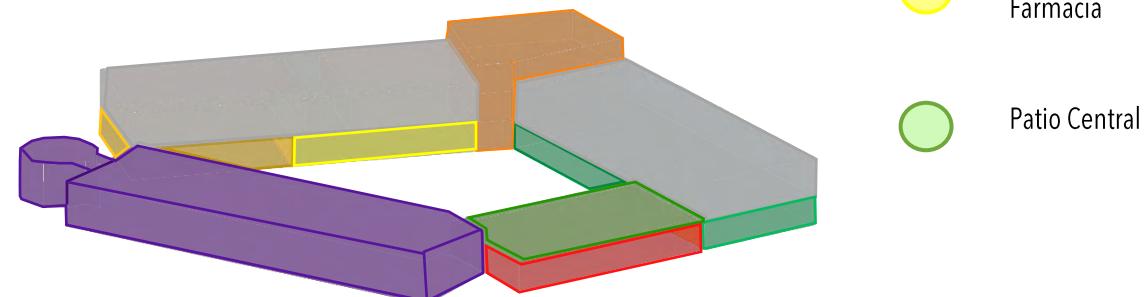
Zonificación de Planta Baja (nivel +.60m) en volumetría.
